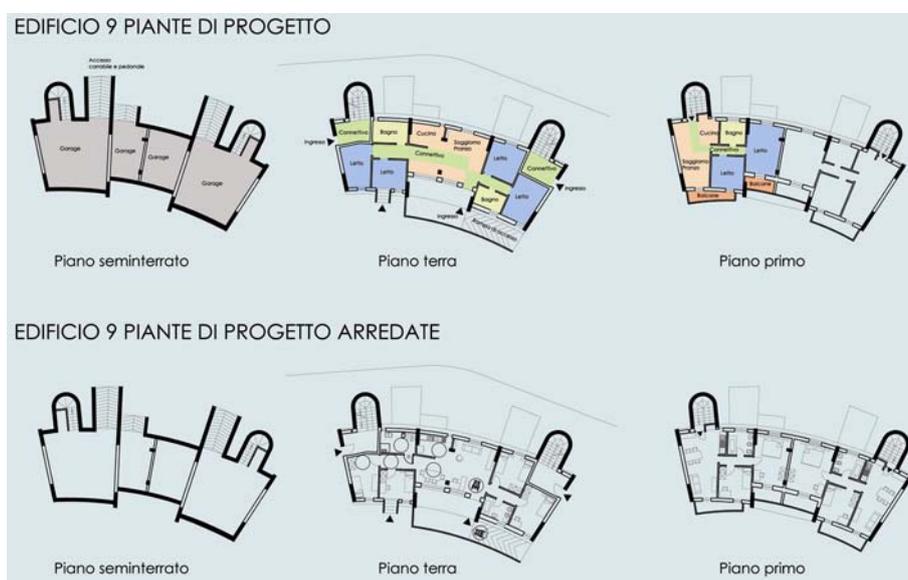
Edificio 9 – Pianta di progetto dell'Alloggio "speciale " per utenze deboli accessibile ai sensi del D.M. n.236/89
